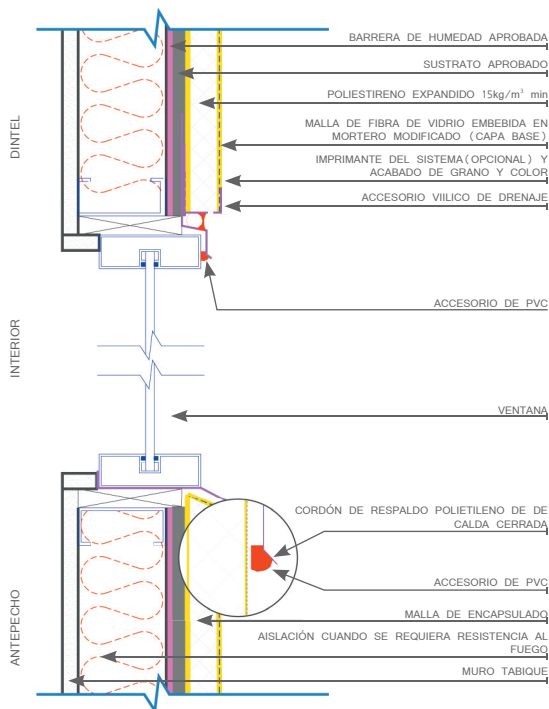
j: Detalle constructivo de encuentro con vanos, sistema EIFS con drenaje, (vista corte vertical).
